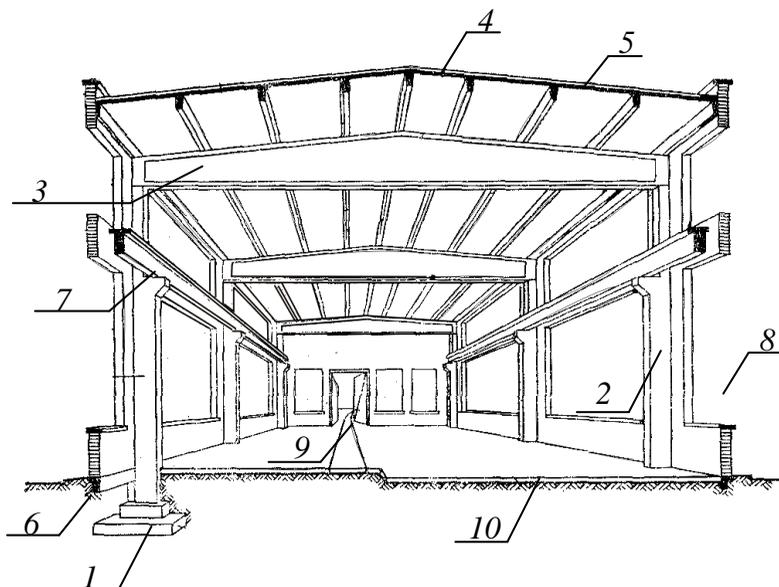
Конструктивные элементы одноэтажного производственного здания: 1 — фундамент; 2 — колонна; 3 — стропильная балка; 4 — плита покрытия; 5 — кровля; 6 — фундаментная балка; 7 — подкрановая балка; 8 — окно; 9 — ворота; 10 — пол
